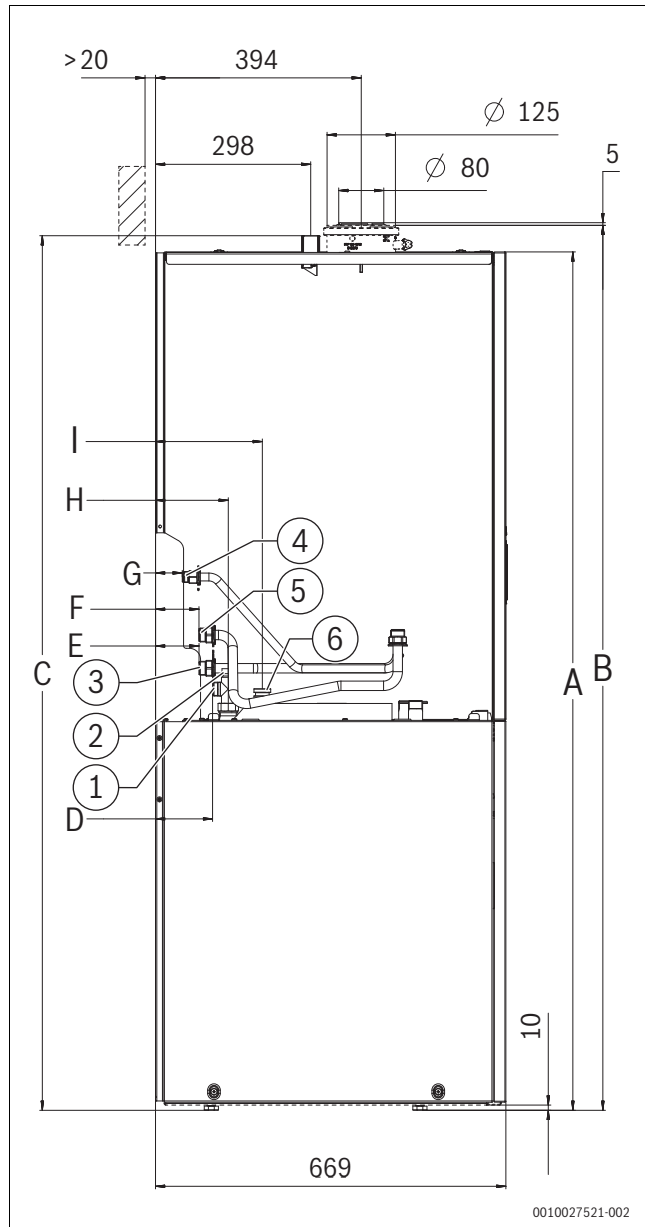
Vedere de pe partea stângă (dimensiune în mm)
